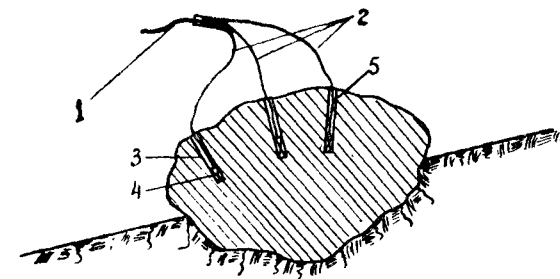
Схема расположения шнуровых зарядов при дроблении крупного камня:
